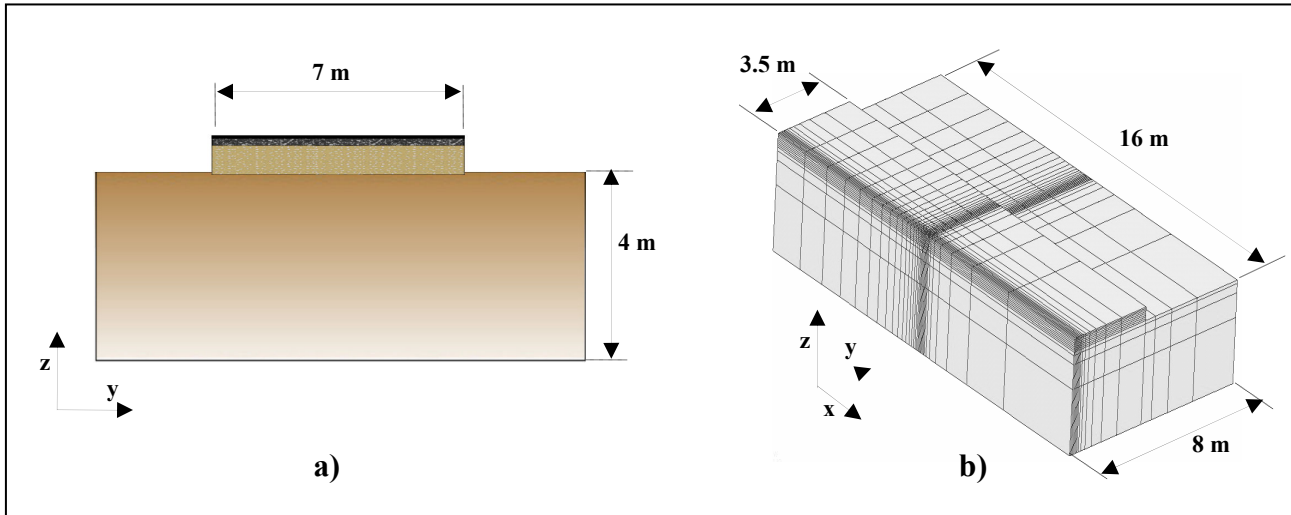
Caractéristiques géométriques de la chaussée modélisée – a) coupe transversale de la chaussée – b) maillage pour une charge placée à l'aplomb de la fissure en couche d'assise
